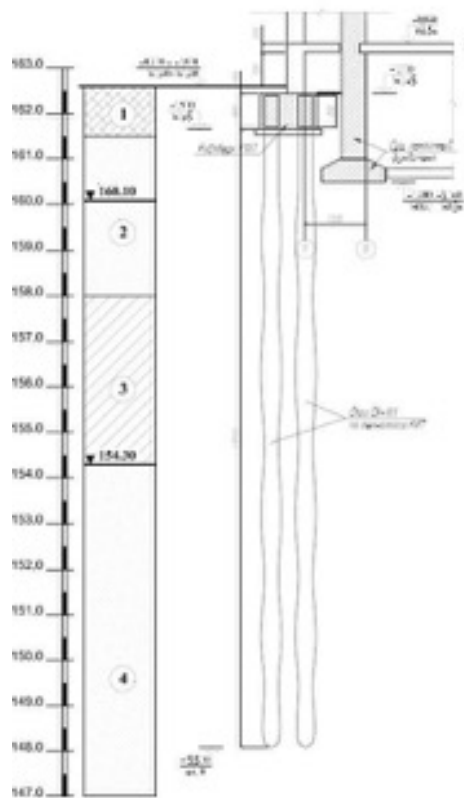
Примыкание свай опор надстройки к существующему реконструируемому зданию.
